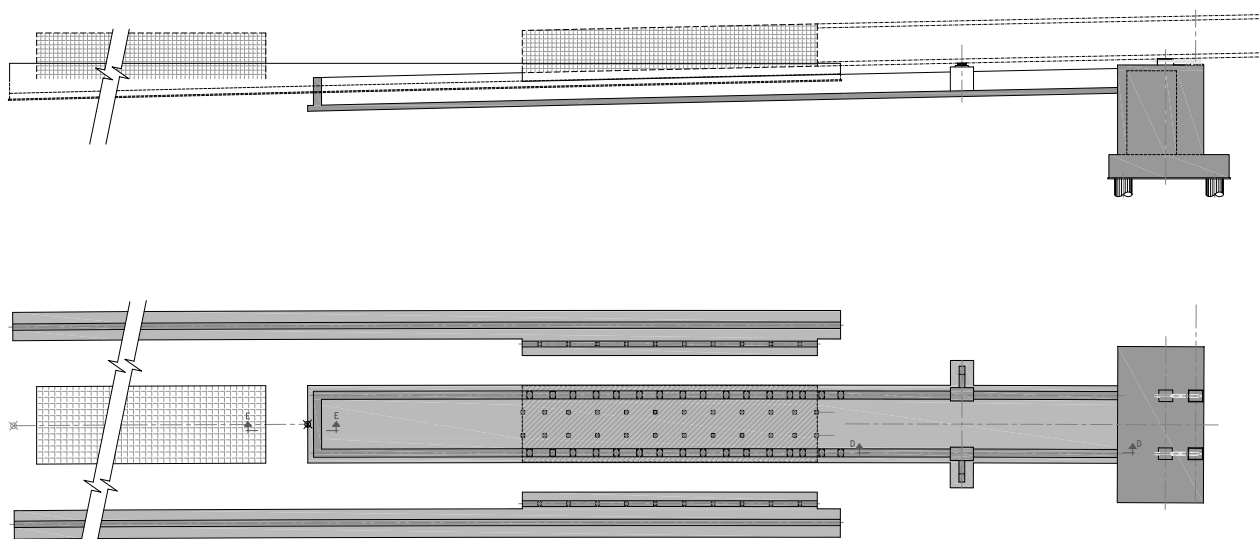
Parque de fabricación de puente empujado. Planta y alzado
